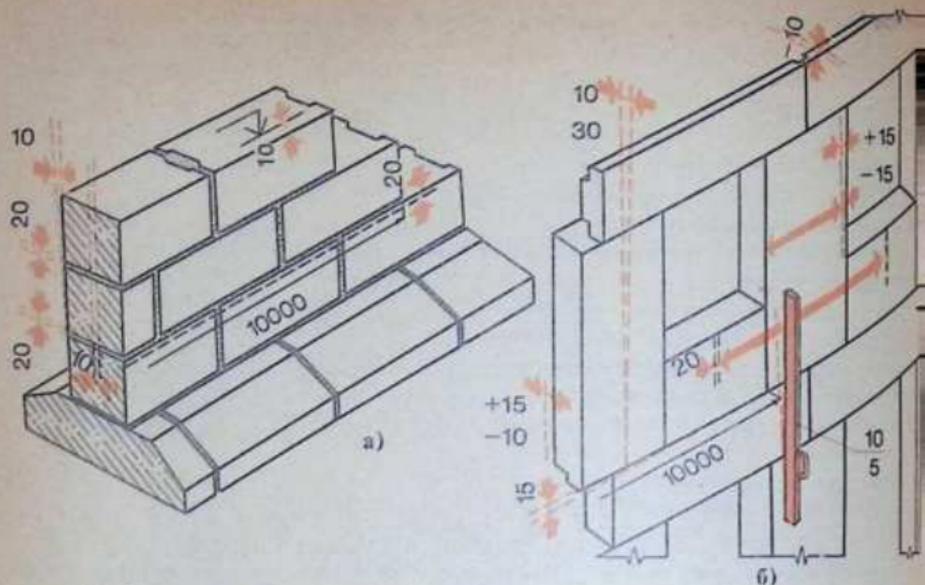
Допускаемые отклонения при кладке из крупных блоков: а — фундаментов, б — стен (пунктирными линиями обозначены границы допускаемых отклонений)
